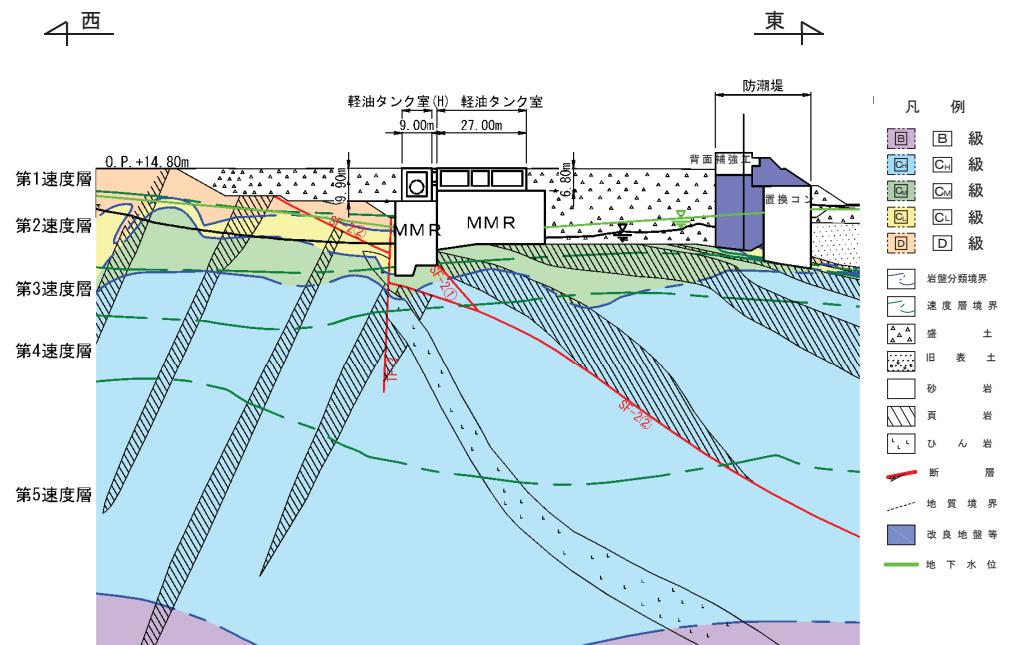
軽油タンク室地質断面図 (B-B, ポンプ室)
